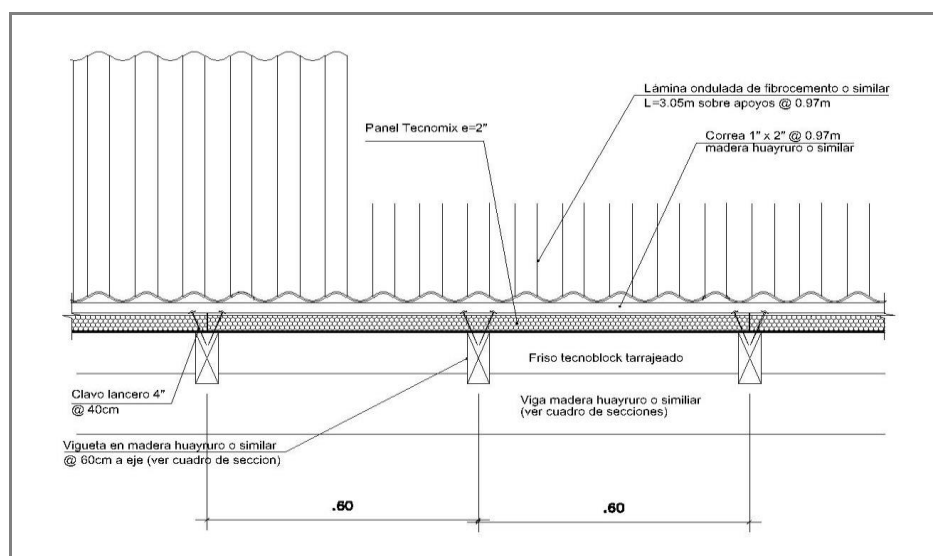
Detalle constructivo cobertura con panel TECNOMIX y lámina ondulada.
